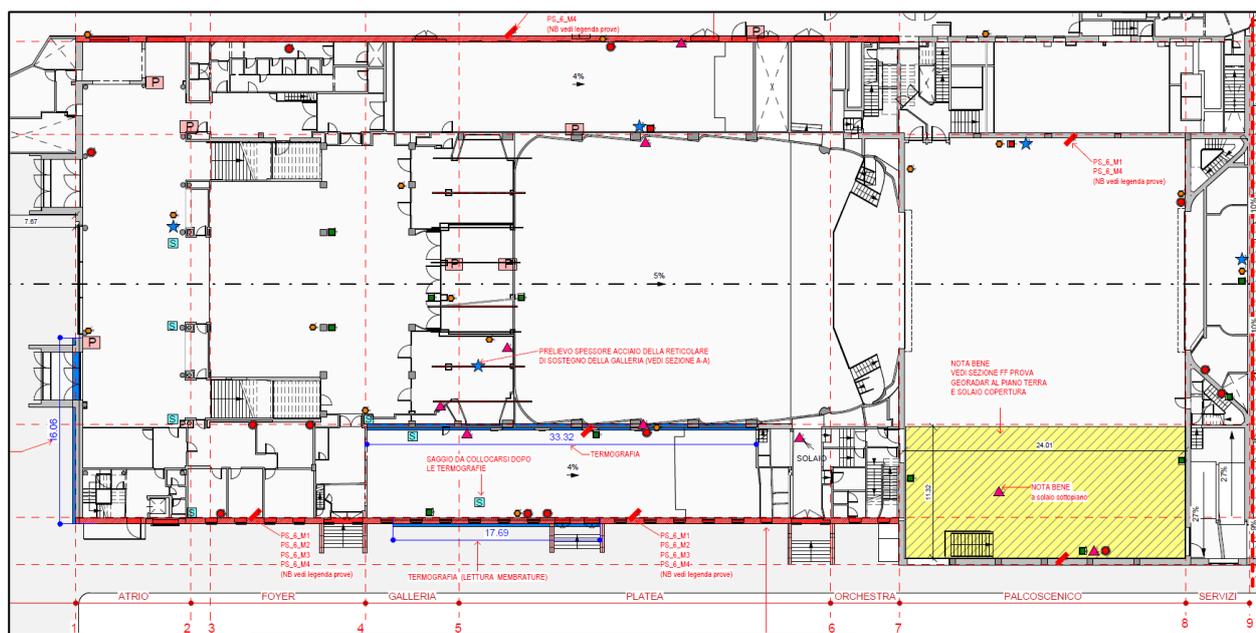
Pianta piano Terra in condizione attuale del Teatro Nuovo
